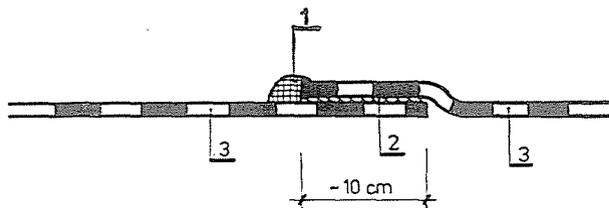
PVC-Dichtung mit doppelter Stoßverbindung. 1. Endabschluß mit flüssigem PVC, 2. Heißluftschweißstelle. 3. PVC-Dichtungsplatte
